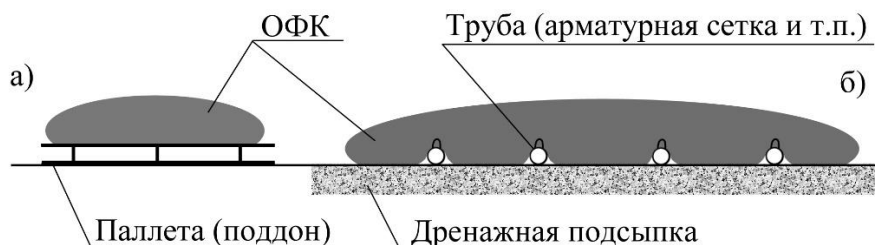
Варианты размещения ОФК на площадке: а) на поддонах (паллетах); б) на дренирующем слое.
